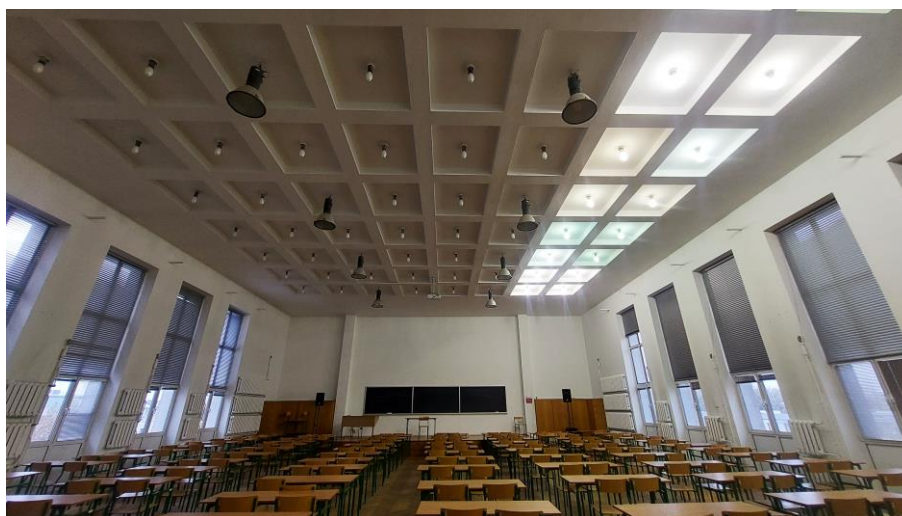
Widok konstrukcji stropodachu nad aulą.
